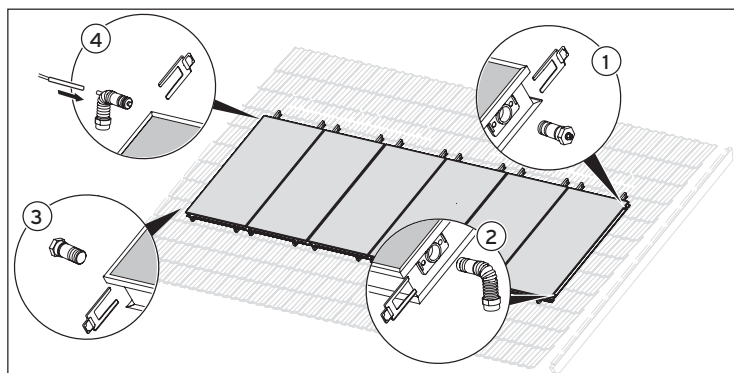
Montáž hydraulických prípojok (1 - 5 kolektorov)
